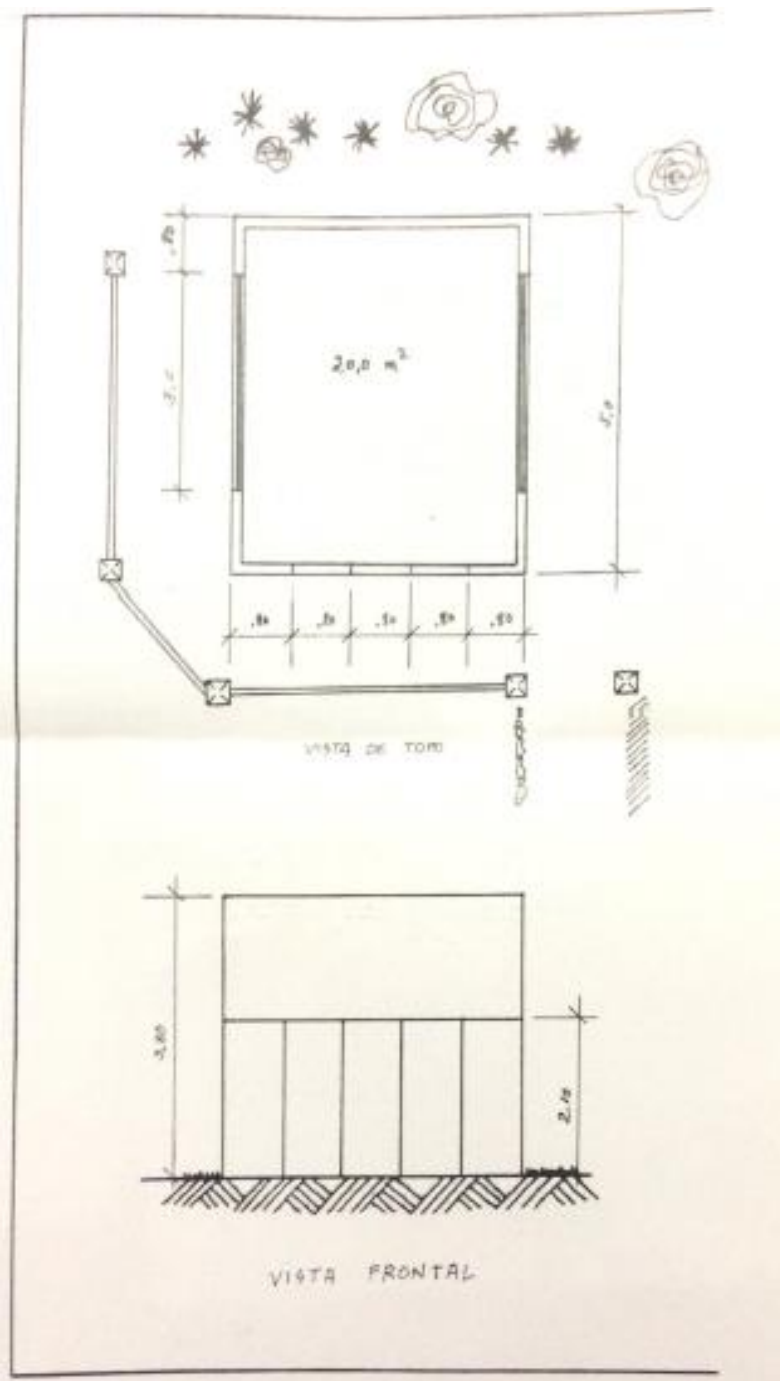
Desenho arquitetônico (planta baixa) da instalação *New House*, de Lygia Pape
